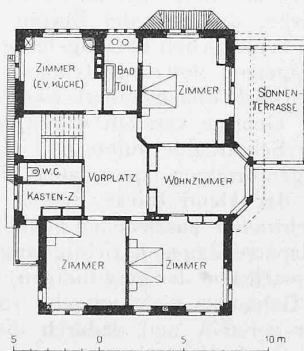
Grundrisse der Villa «Haldegg» an der Arosastrasse in Zürich V.
